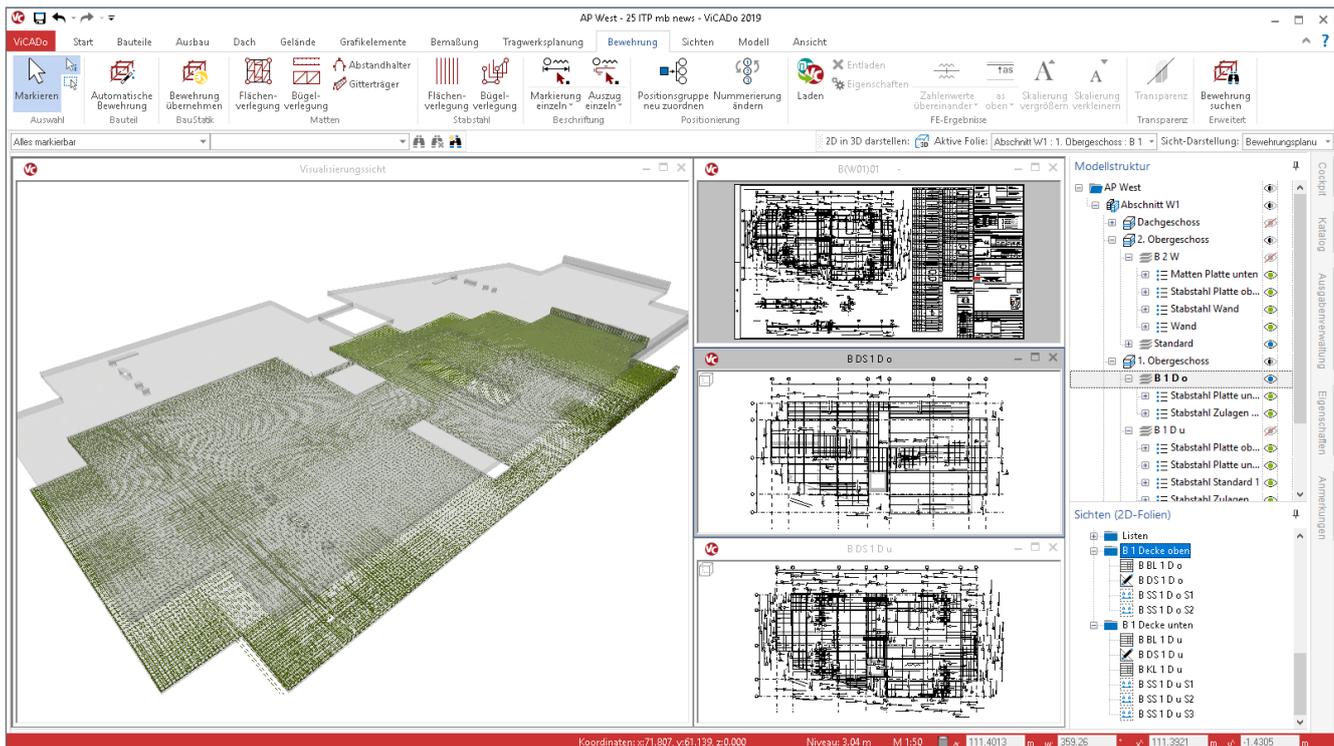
Bewehrung und Bewehrungsplan für die Decke über dem 1. Obergeschoss
